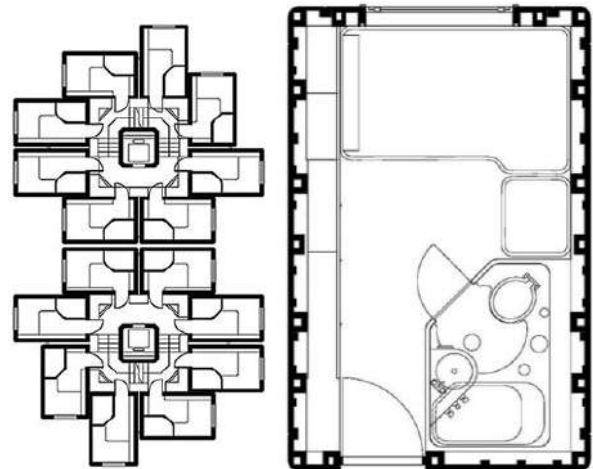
PLANOS DE LAKE SHORE DRIVE.
